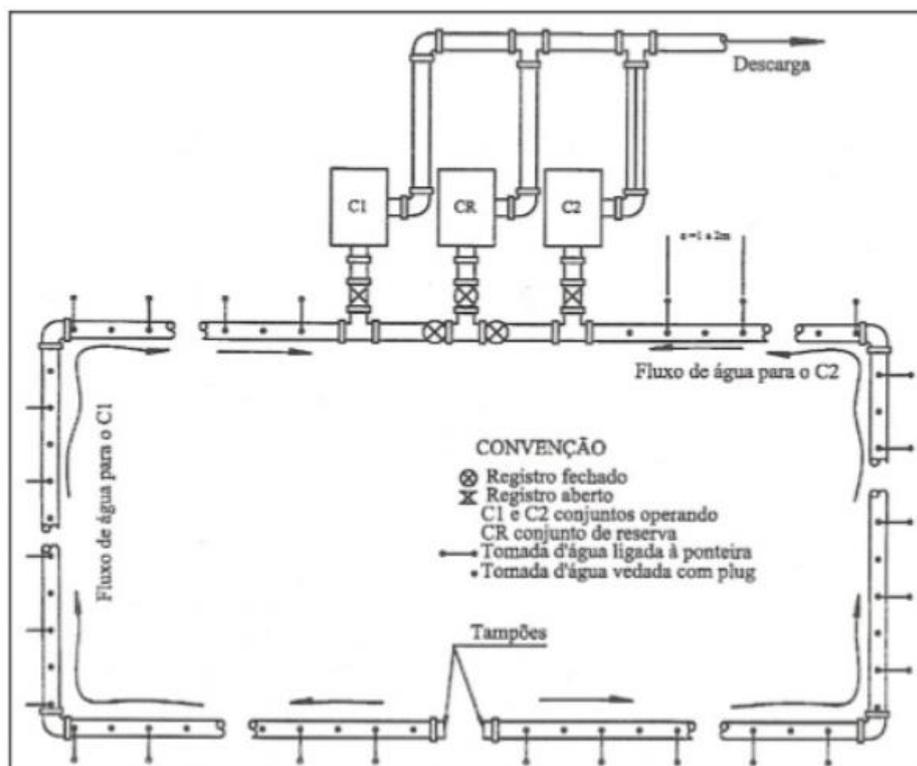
Planta esquemática de localização do sistema de ponteiros filtrantes
